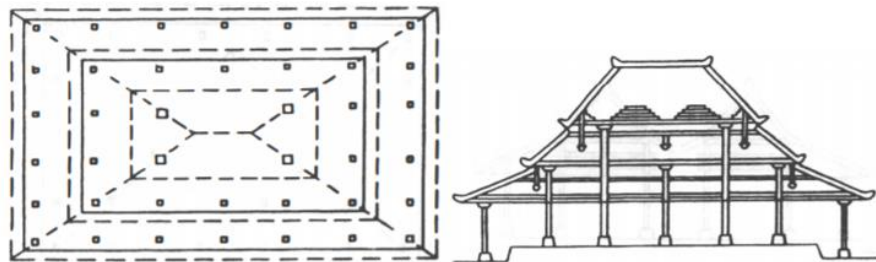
Denah dan Potongan Omah Joglo Lawakan
